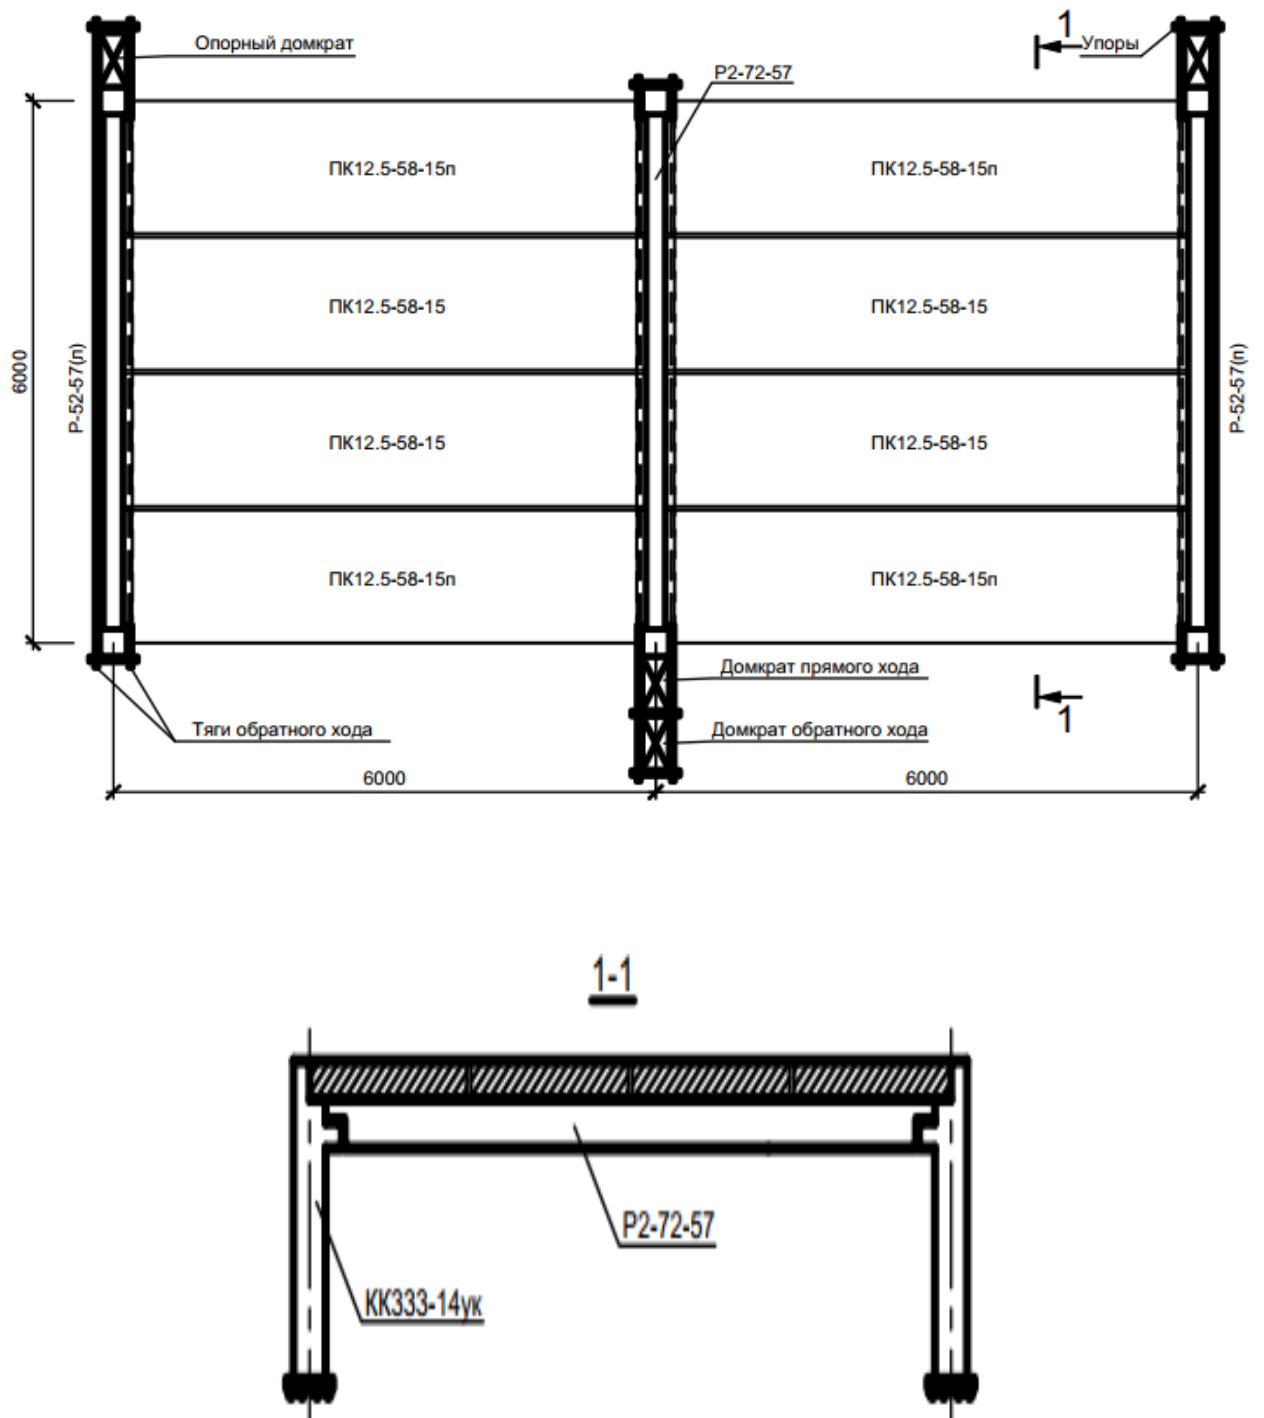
Схема фрагмента (ФП-2) двухпролетного перекрытия из четырех связевых и четырех рядовых многопустотных плит с заполнением только торцевых швов и не замоноличенных продольных швов.
